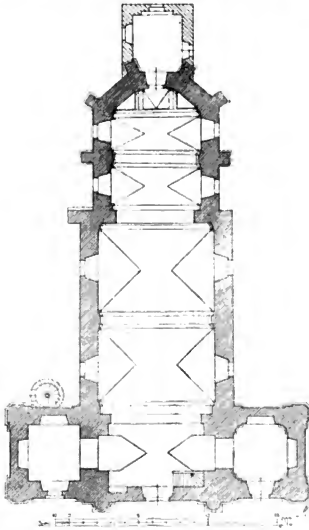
Heiligfeld. Grundriss der Kirche.
